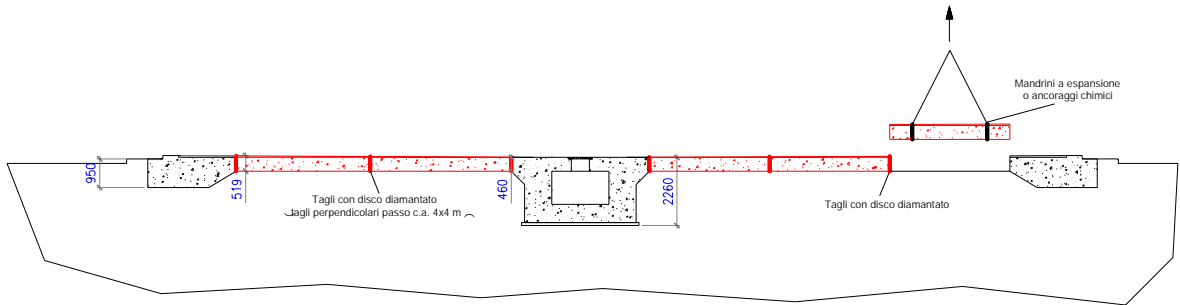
taglio e rimozione sezioni intermedie fondazione
